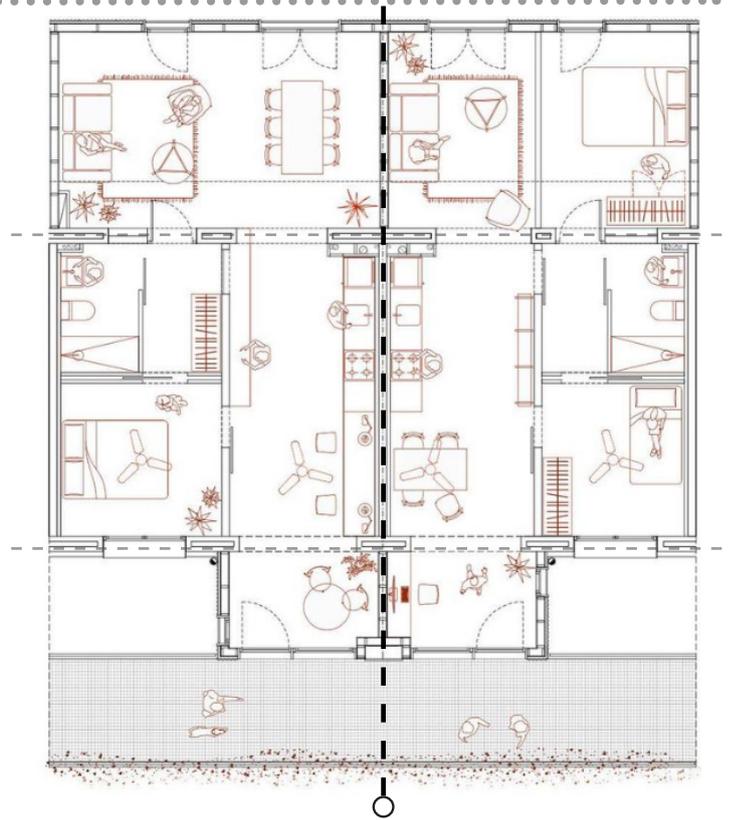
Planta de vivienda 60 m<sup>2</sup> de Clau Mestra
